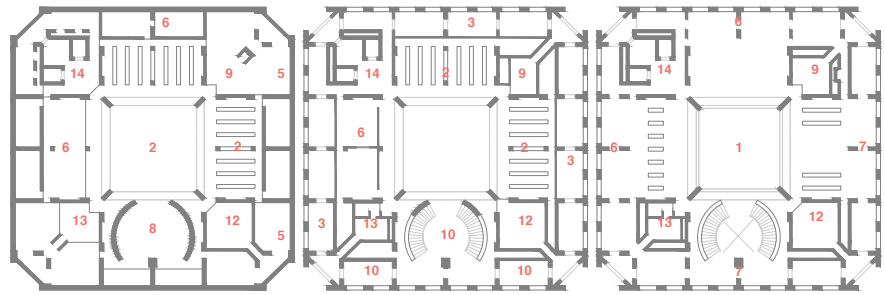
Planta de Implantação de 1967, Louis Kahn.
